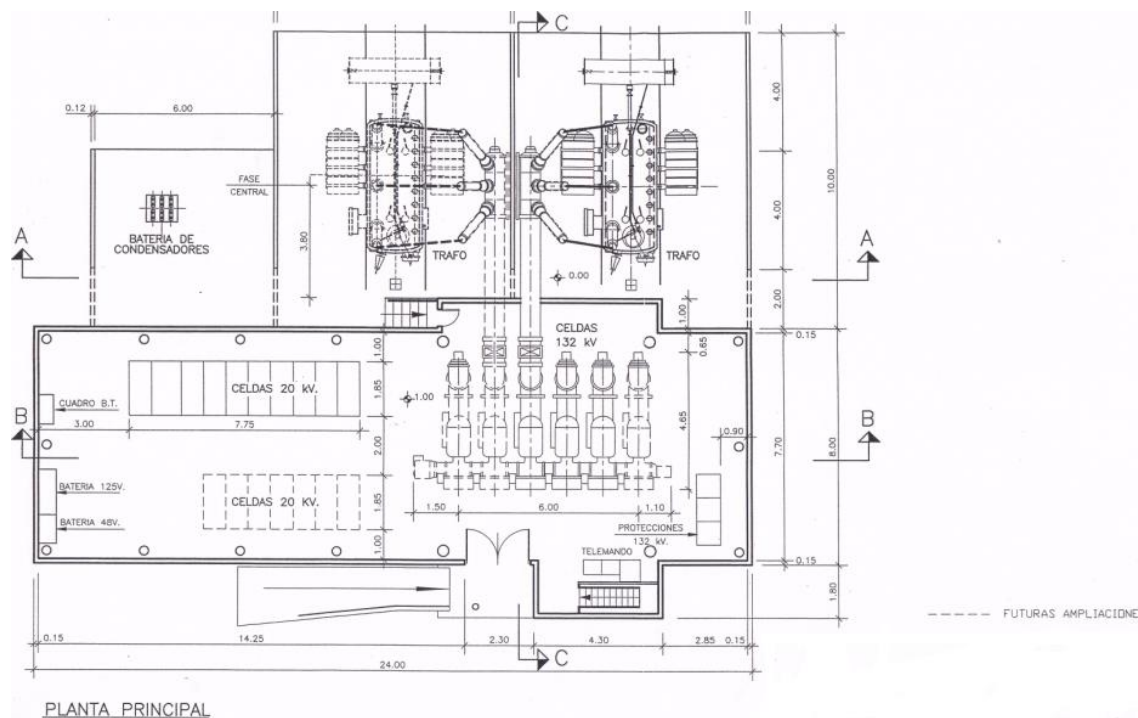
Plano de secciones de una subestación blindada rural de 132/20 kV.
